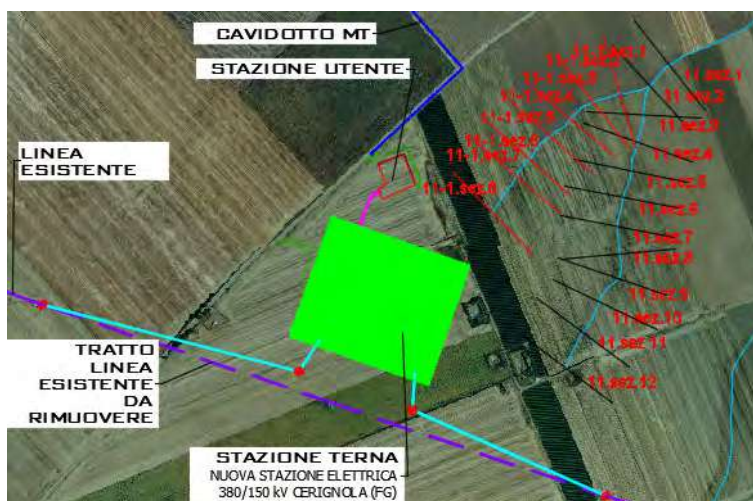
Planimetria con indicazione del reticolo e delle sezioni su ortofoto
